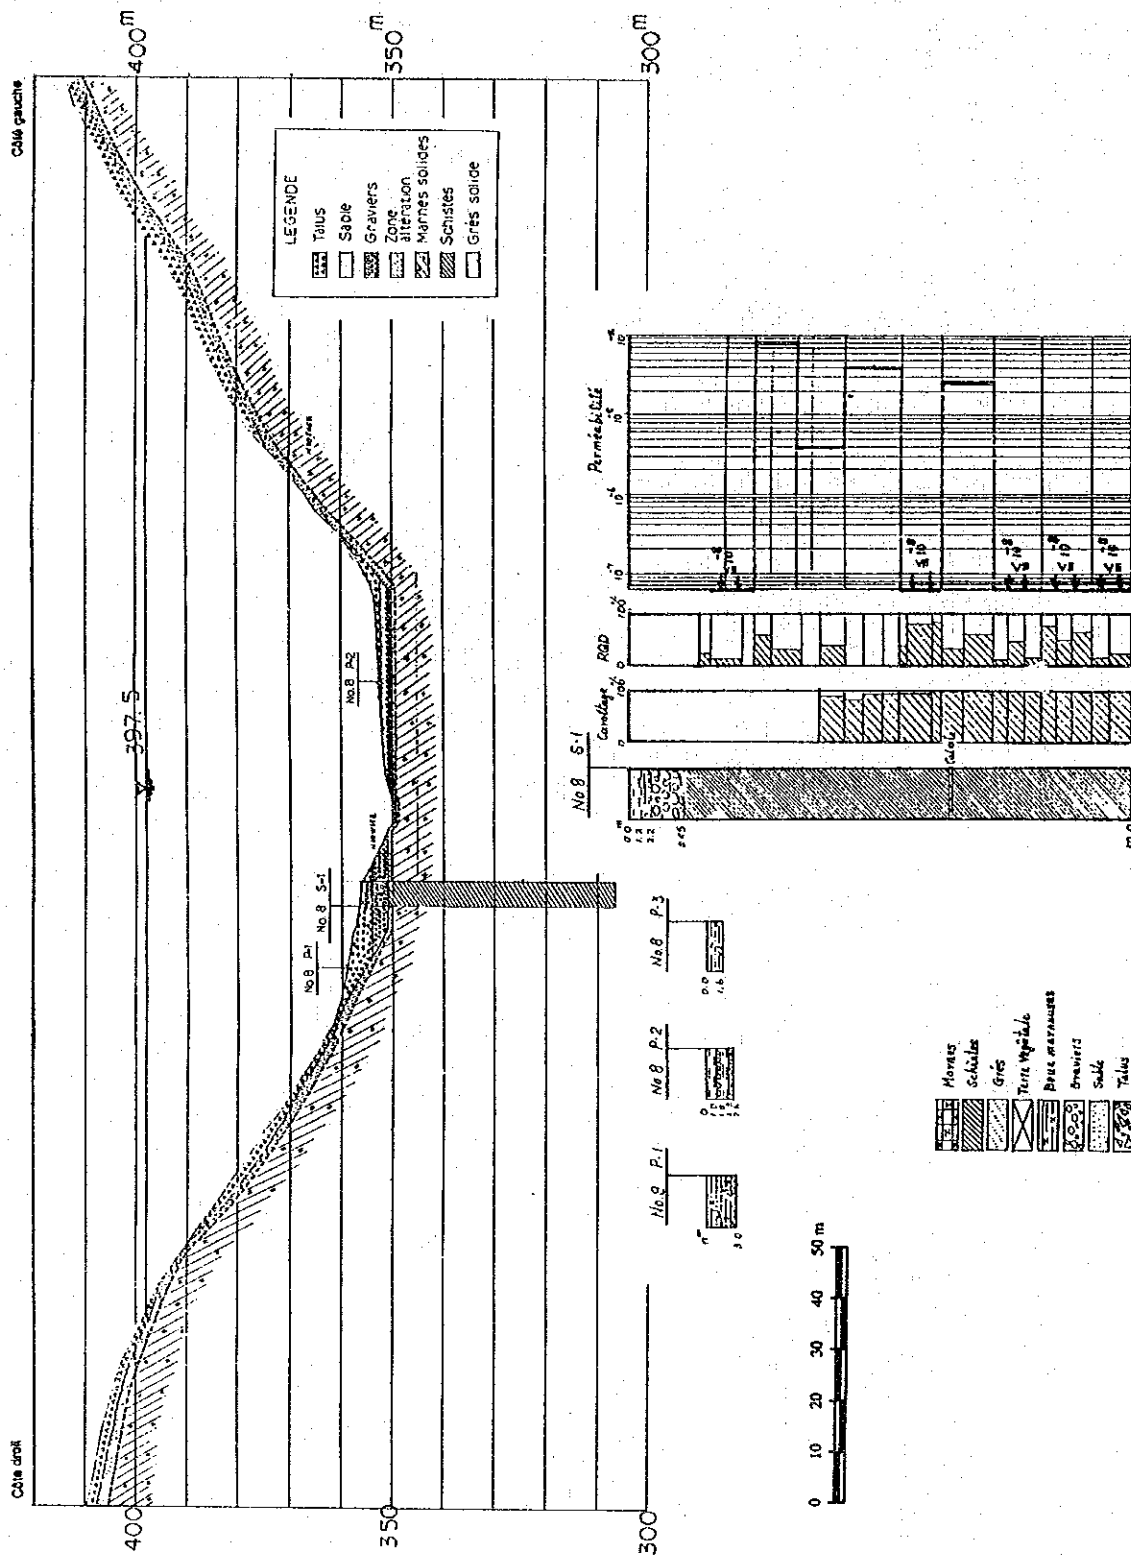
Coupe géologique du site du barrage No. 8
